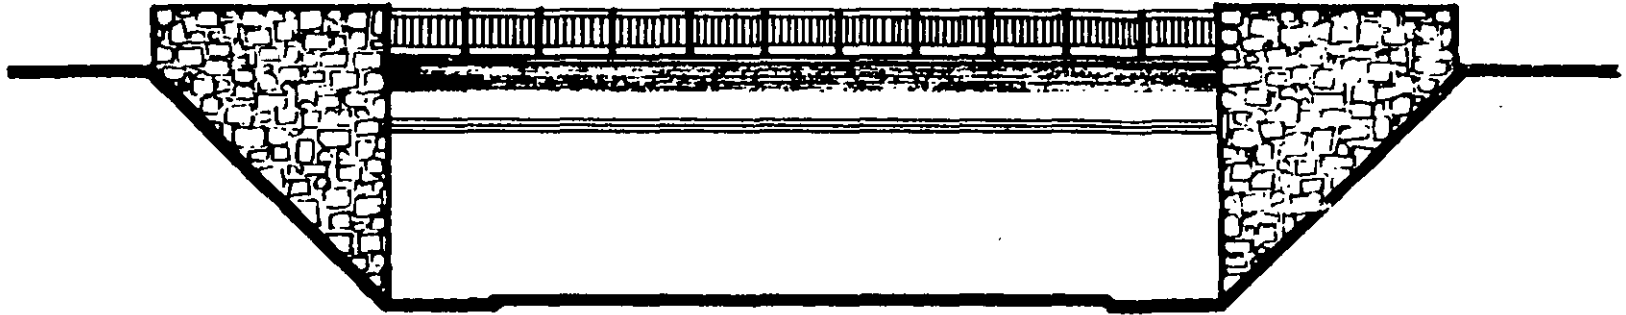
PARAPETO METALICO CON REMATES DEL MISMO MATERIAL QUE LOS ESTRIBOS
